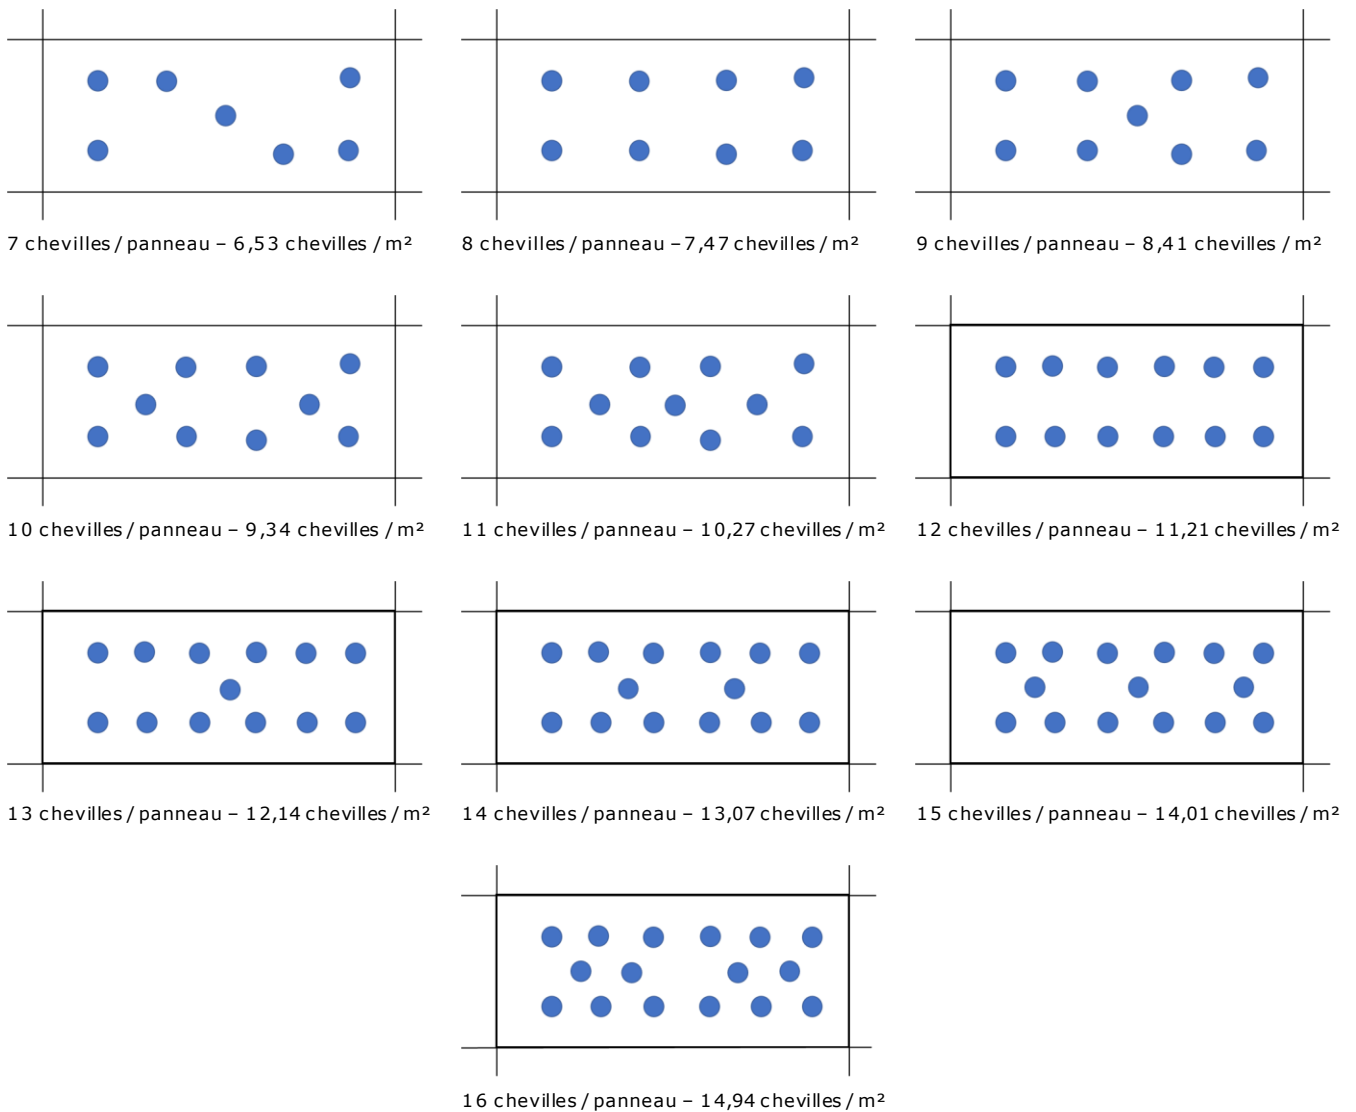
Plans de chevillage – panneaux MULTISOL 140 de dimensions 1872 x 572 mm – chevillage « en plein »
